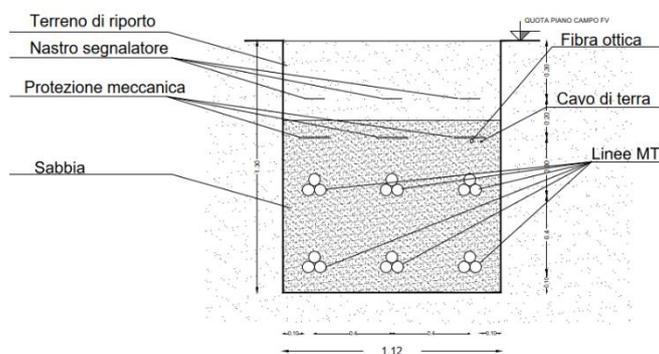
Sezione cavidotto MT interrato a quintupla terna di cavi (Sez. E-E) - estratto tav. GRE.EEC.D.25.IT.P.15533.00.047
